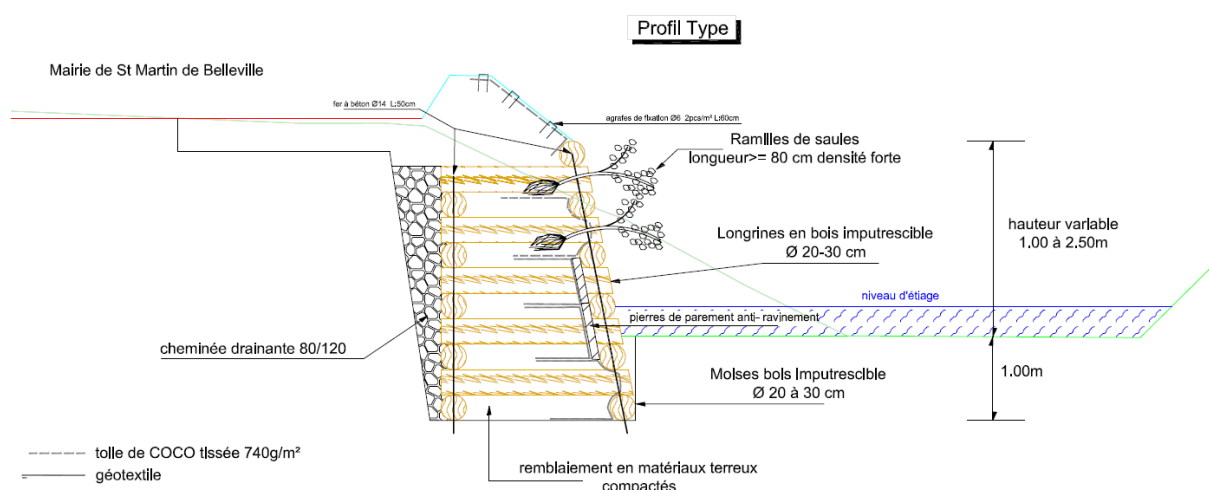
Extrait du plan projet de la protection de berge rive droite en aval du pont 4 (ABEST, 2008)
